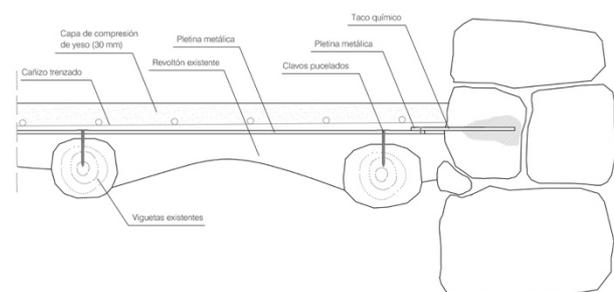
Detalle del refuerzo del forjado y del anclaje del muro con pletinas metálicas.
